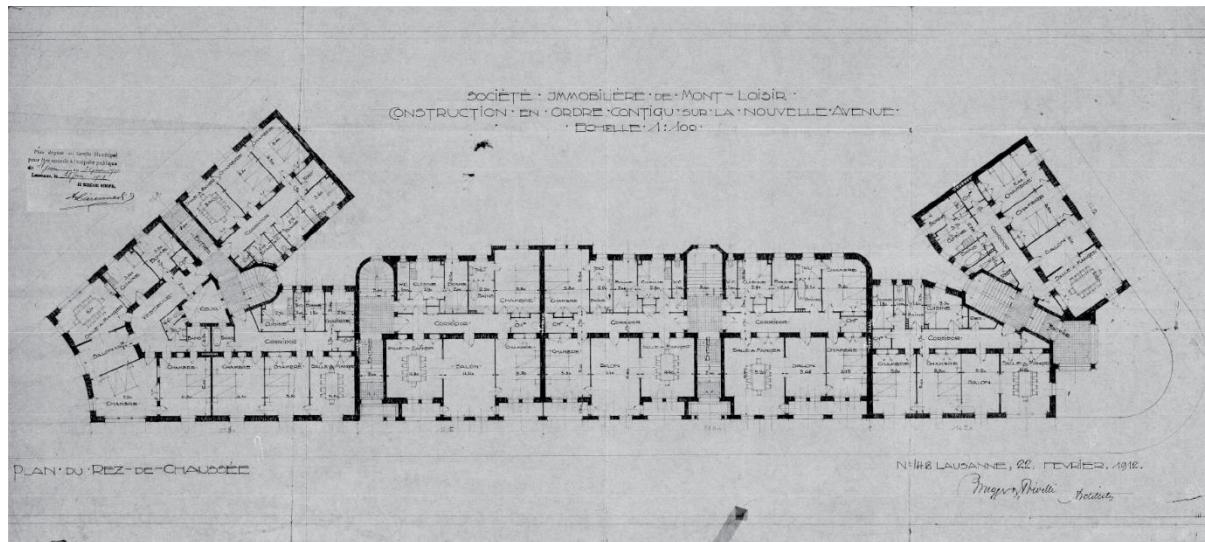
Îlot Mon-Loisir – Plan de rez-de-chaussée – Plans d'enquête de 1912<sup>8</sup>
